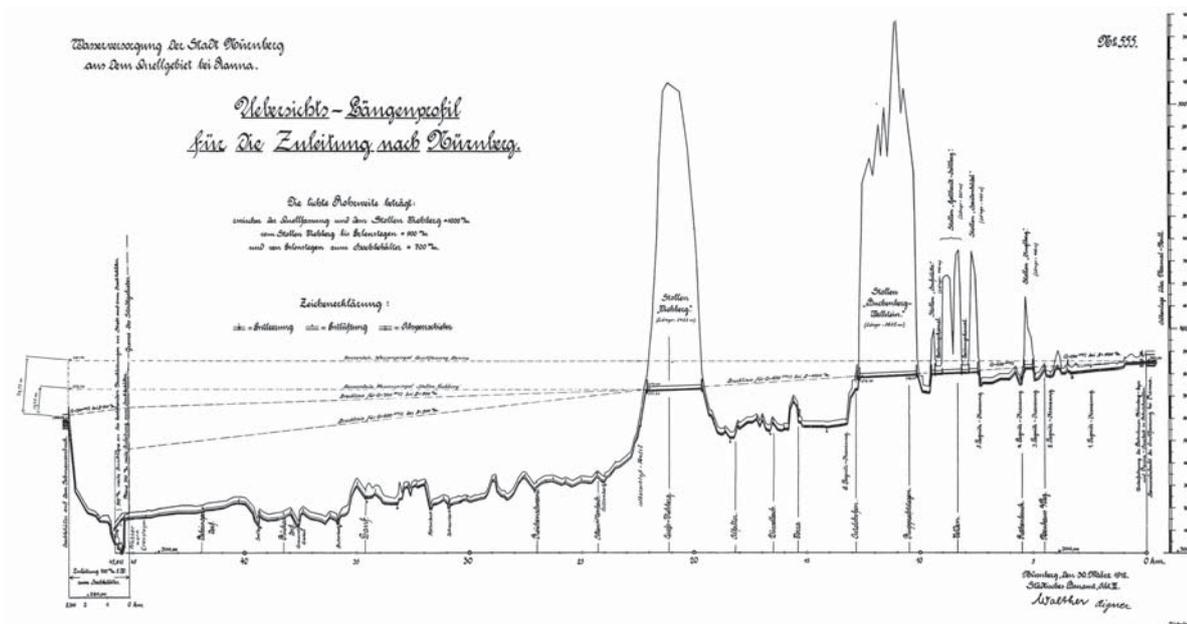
Höhenprofil der Fernleitung (Fischer/Walther 1912, Anhang - Plan).
